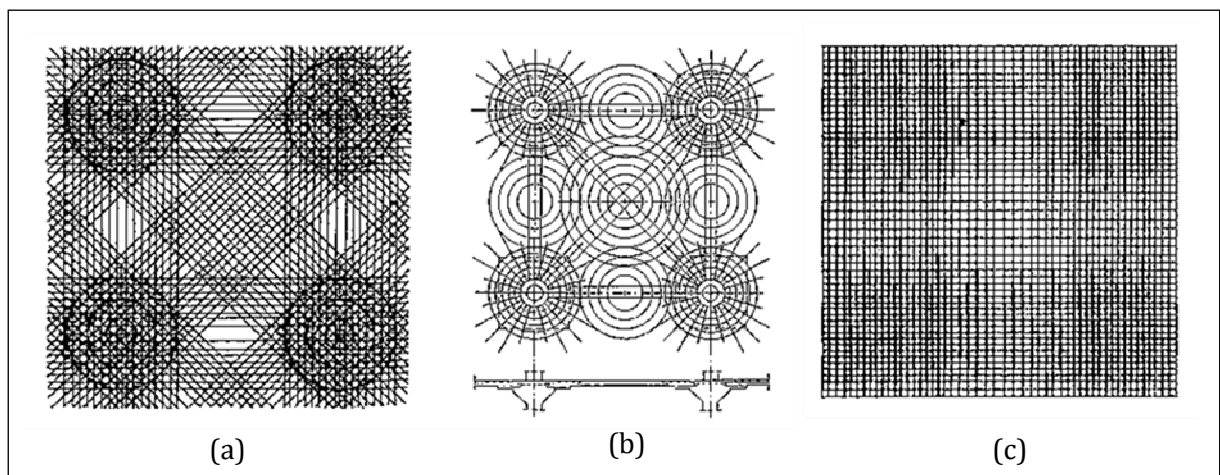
Bewehrungsführung für punktgestützte Platten: (a) Vierbahnenbewehrung nach *Turner*, (b) Ringbewehrung nach *Smulski*, (c) Zweibahnenbewehrung nach *Maillart
